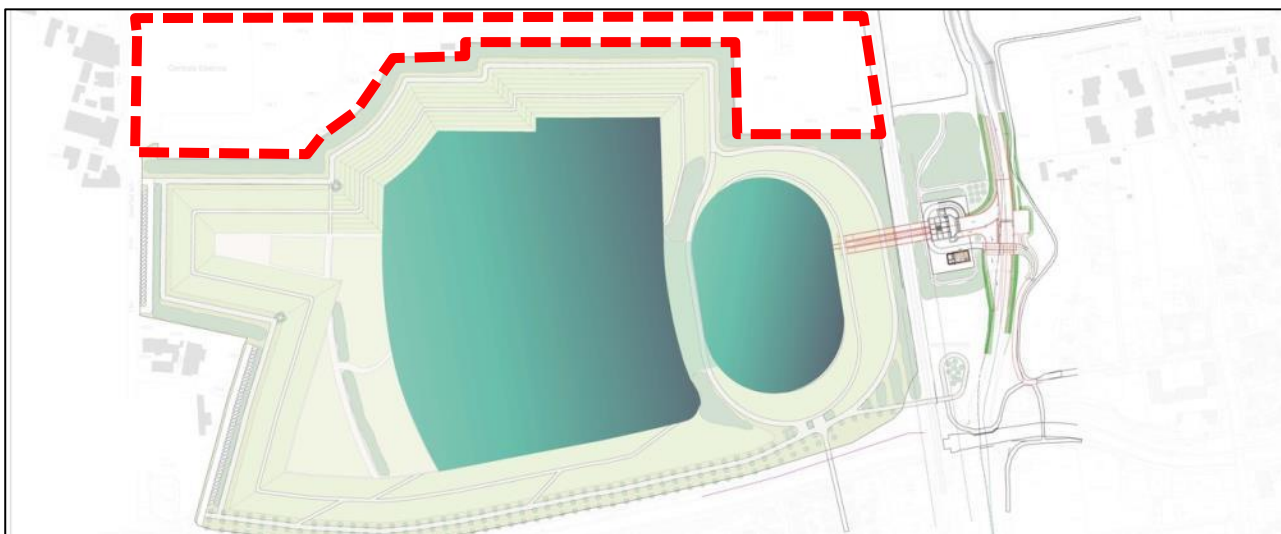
rendering planimetrico della vasca di Varedo con la parte meridionale dell'area in esame (in rosso)
